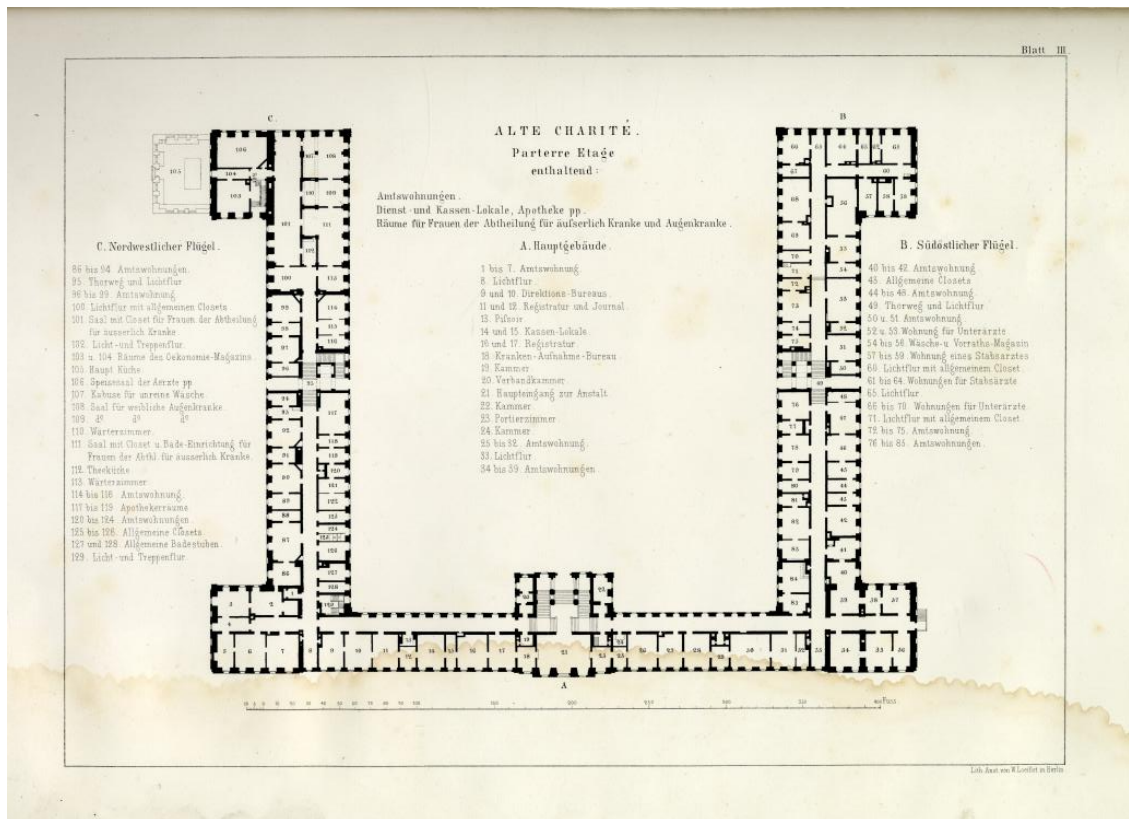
Grundriss der Alten Charité, Erdgeschoss (Grundrisse 1865 Blatt III)
